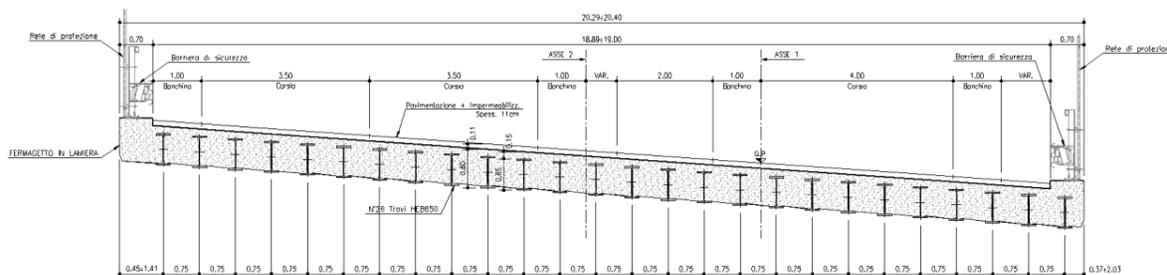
Sezione dell'impalcato sottovia di accesso al casello
